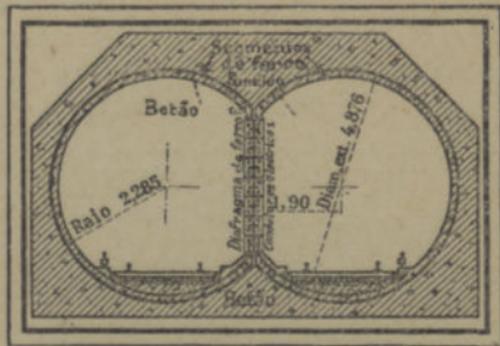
Seção do tunel duplo sob o Harlem River.
